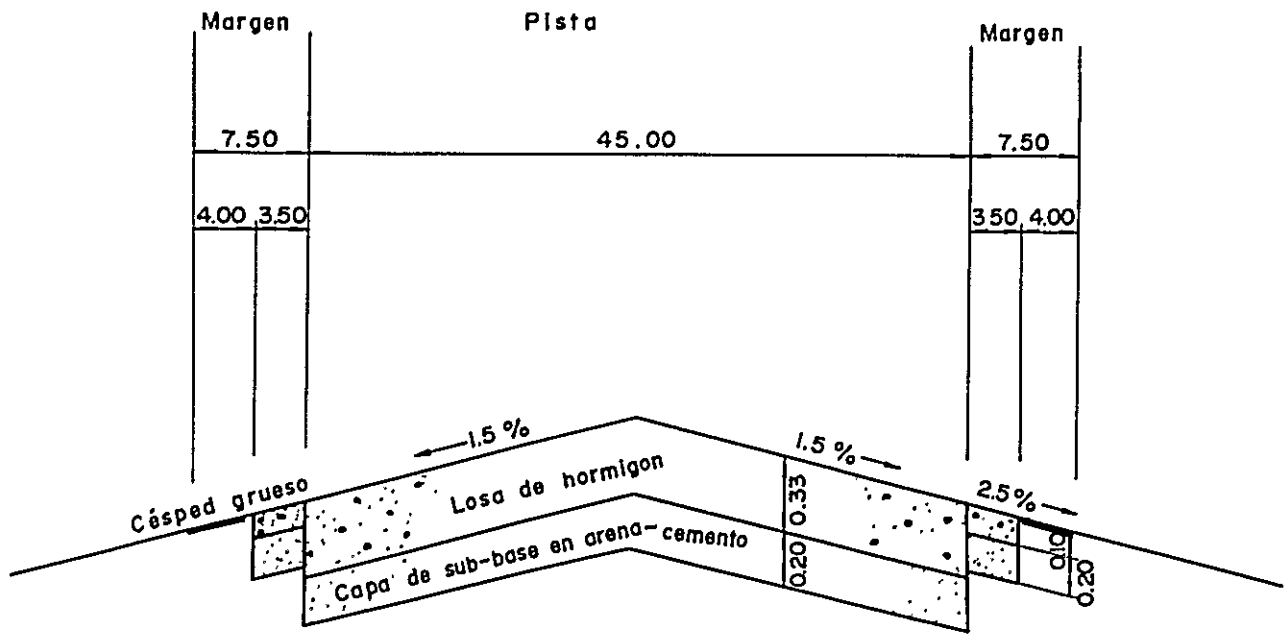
Sección Típica de Pavimento Rígido - Pista
